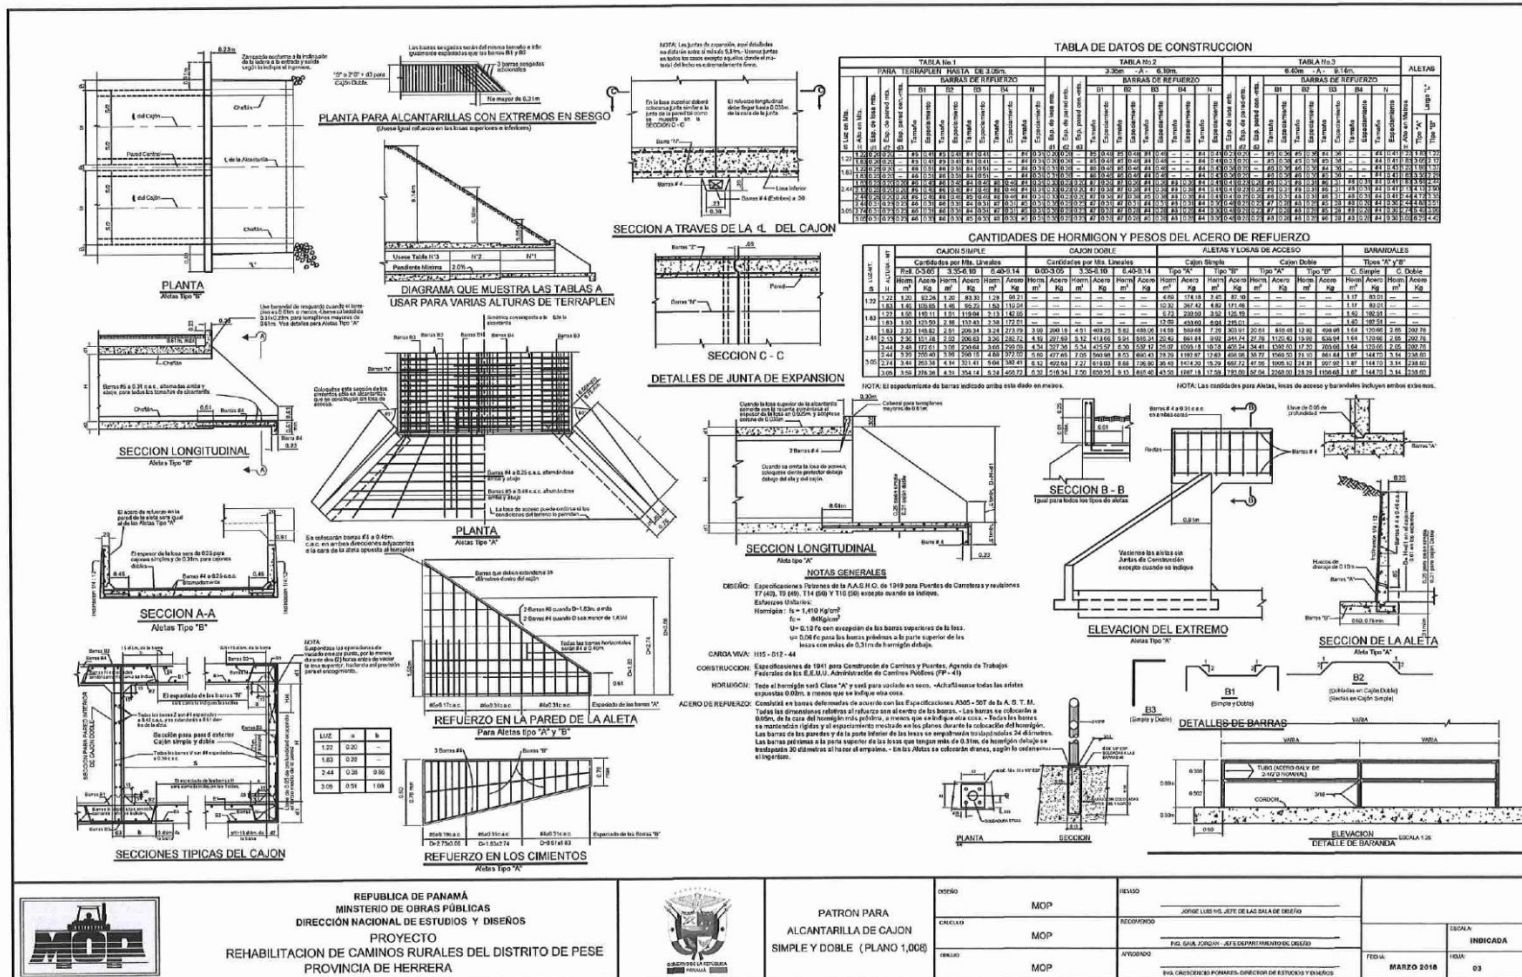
Secciones típicas y detalles típicos de construcción y drenajes pluviales.
